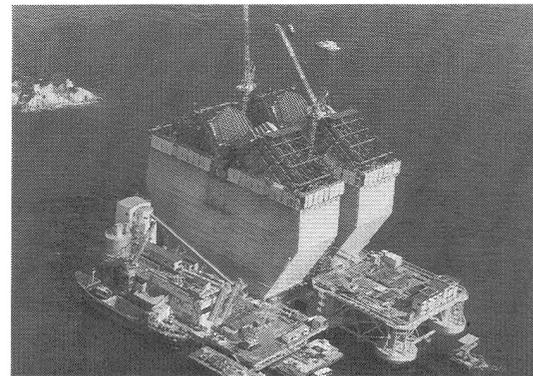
定置式プラント (PCバージ上) によるコンクリート打設状況 (4A)
